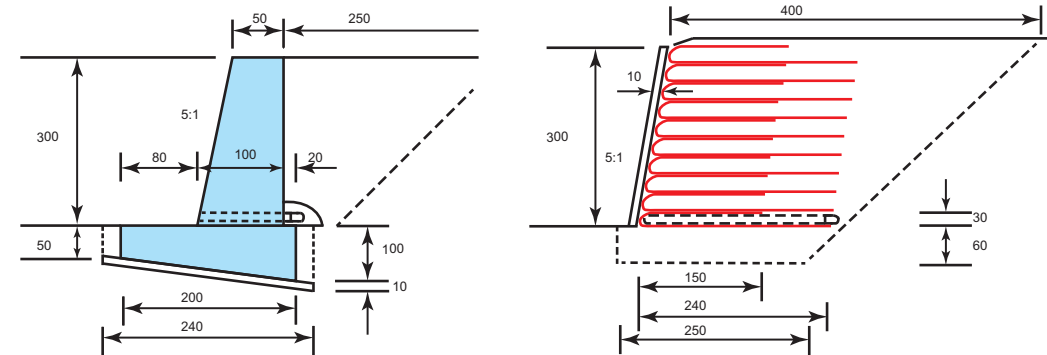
Schematische Darstellung der Stützbauwerke: Betonstützmauer (Fallstudie 4A, links) im Vergleich zur geokunststoffbewehrten Stützkonstruktion (Fallstudie 4B, rechts).
